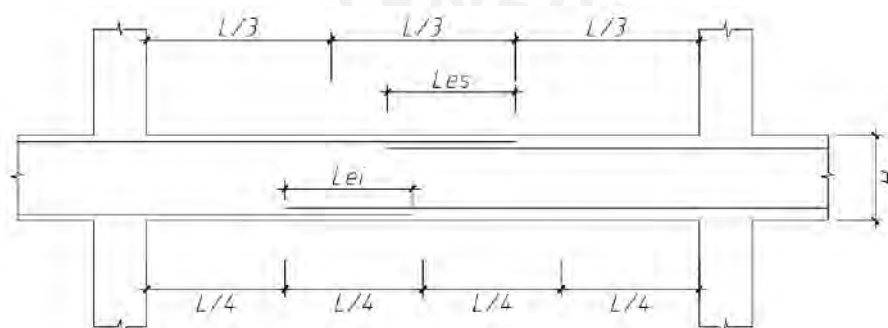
Empalmes traslapados para vigas peraltadas (Blanco, 1994).
